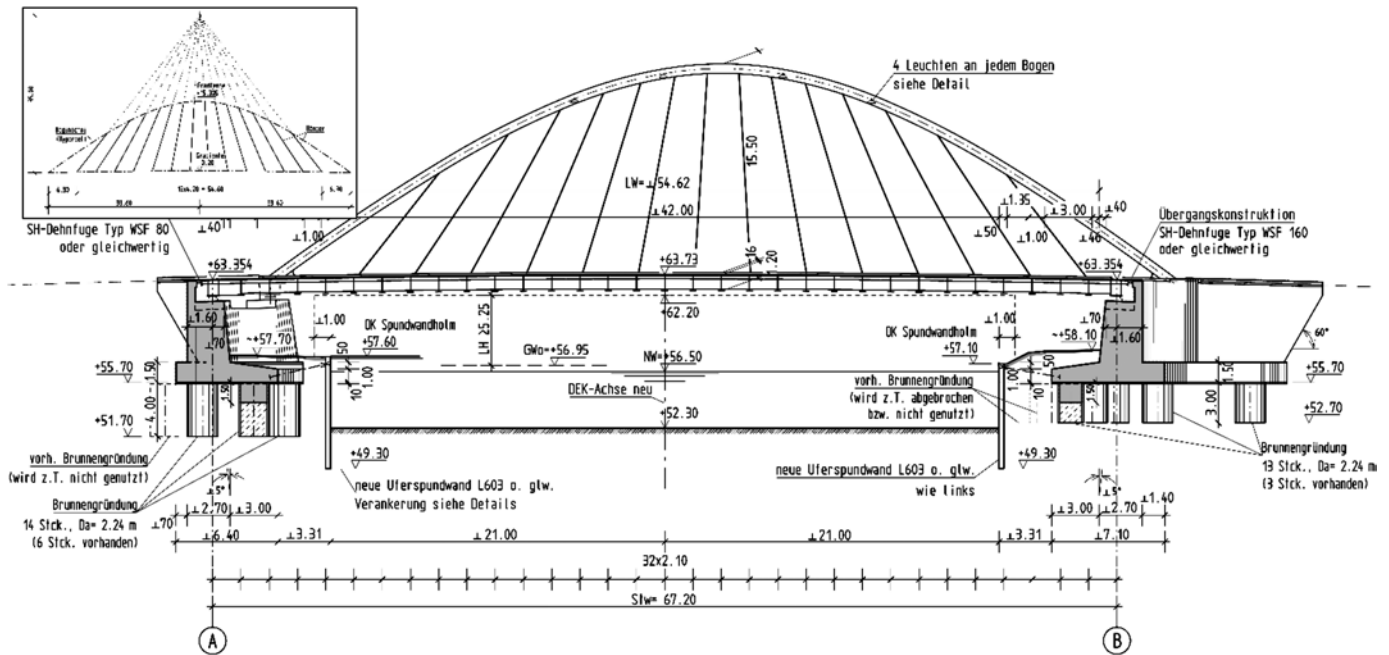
System des Haupttragwerks, Längsschnitt Brücke
